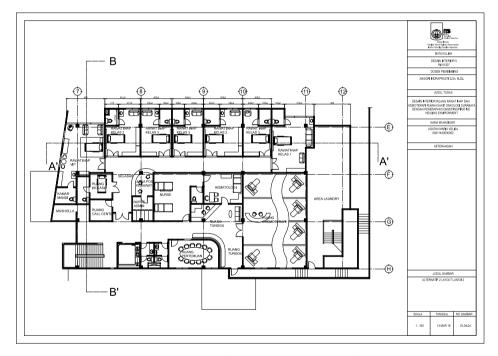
Denah Layout Lantai 1 Alternatif 2
